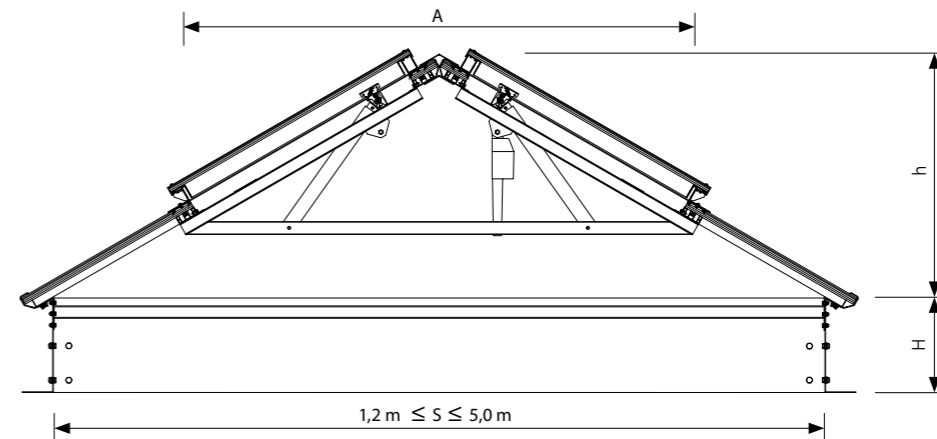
Schnitt D-D durch ein satteldachförmiges Lichtband Typ mcr PROLIGHT mit eingebauter doppelflügeliger Lüftungsclappe
